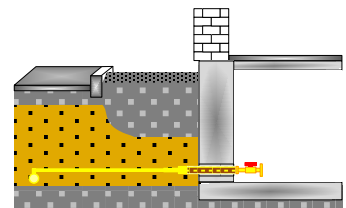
Gebäudeeinführungen Beispiele für Hauseinführungsvarianten
